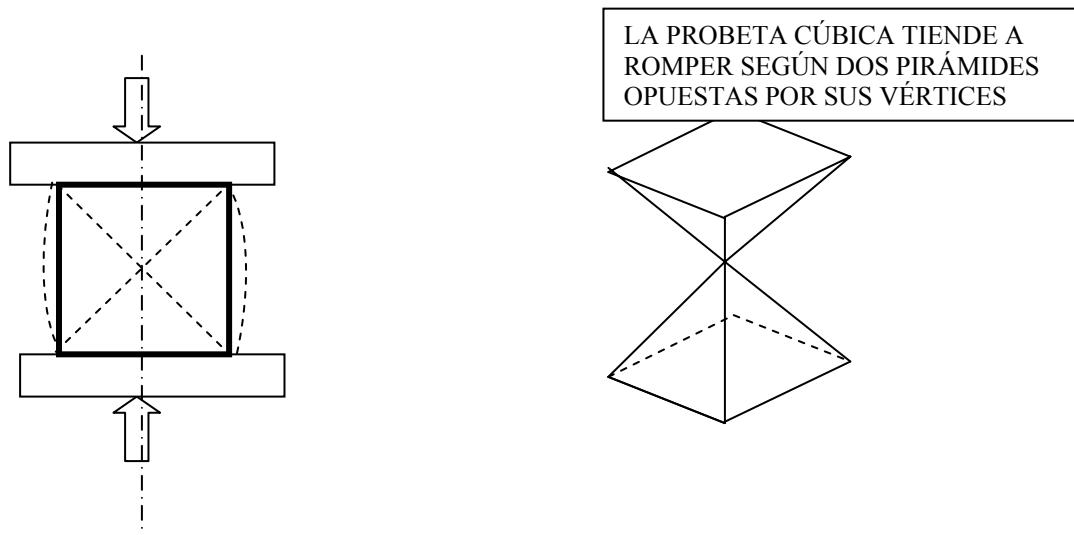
b): Mecanismo de rotura por compresión de una probeta cúbica
